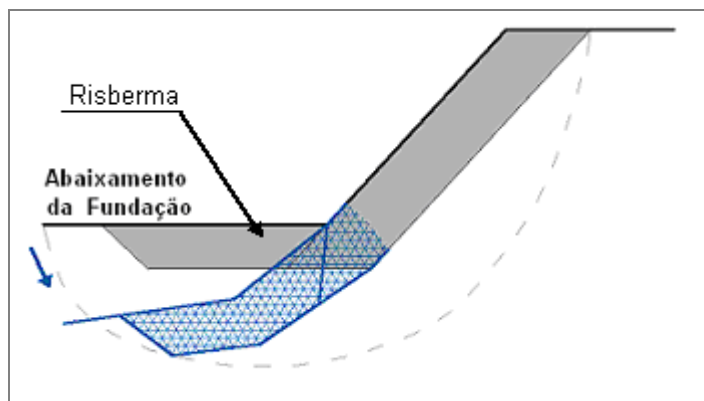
Forma de rotura por assentamentos na fundação de uma obra longitudinal aderente e colocação de uma risberma para mitigar o problema.
